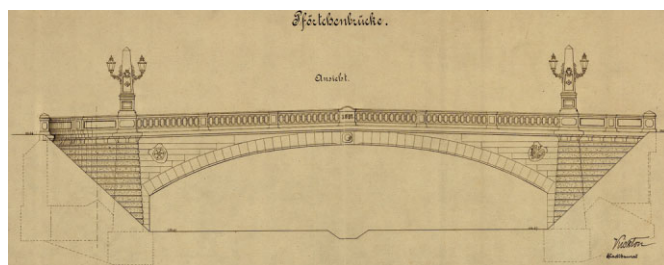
Pfortchenbrücke – Bauwerksplan – HERMANN KICKTON – 1897
